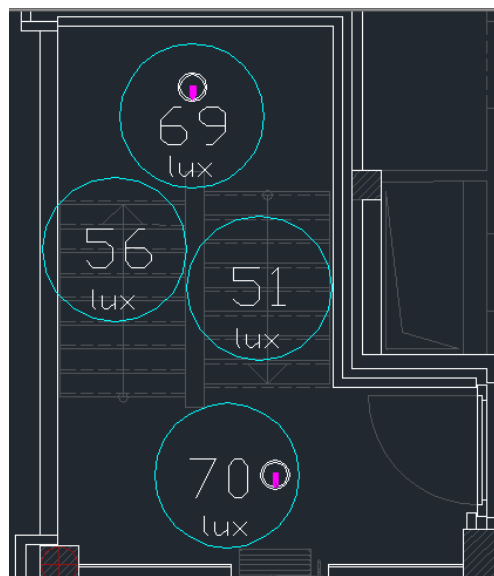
Planta Autocad das Escadas entre o Piso 0 e o Piso 1
